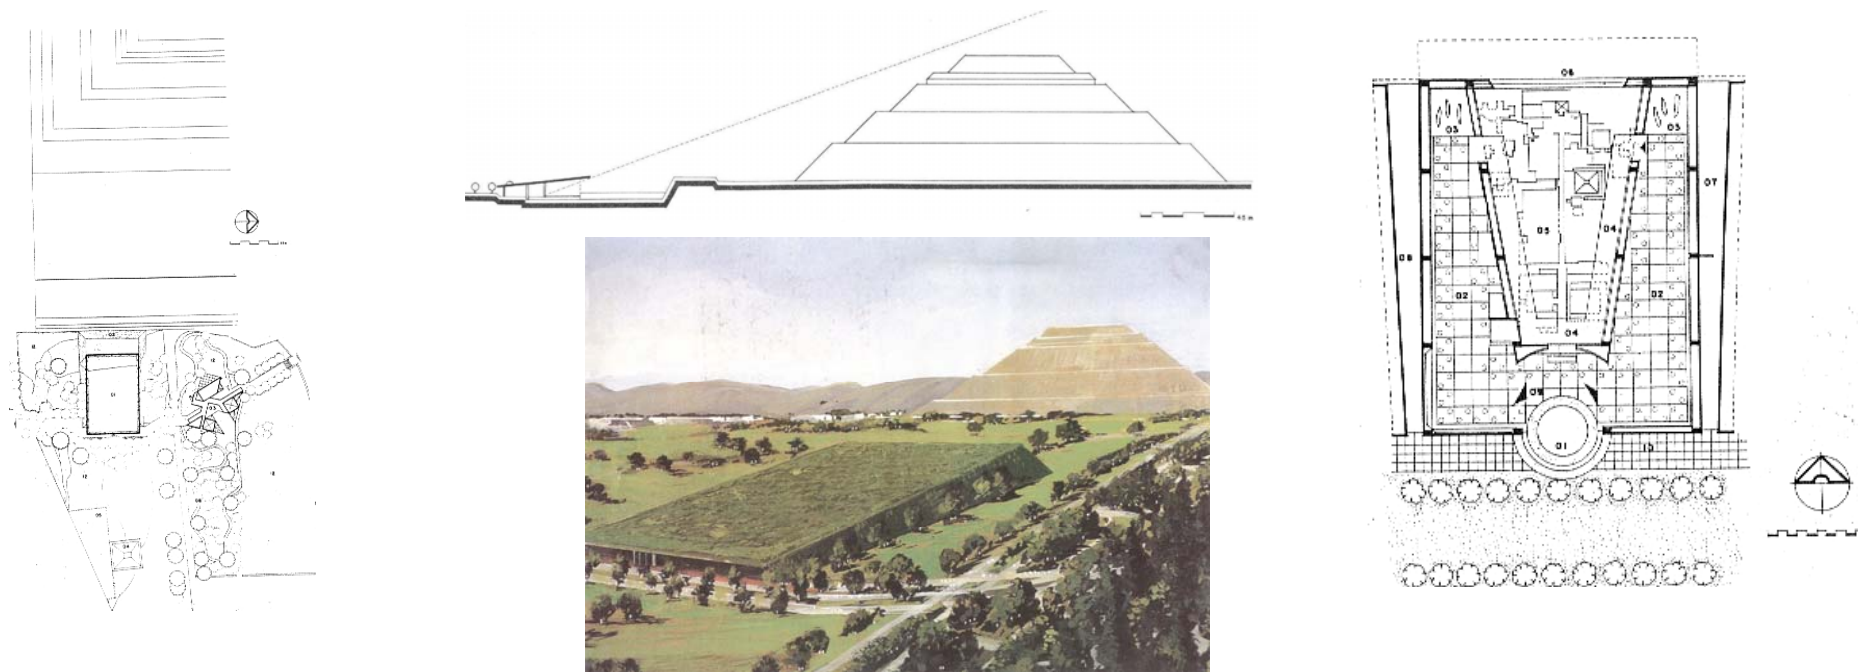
Plantas Arquitectónicas y Corte del Museo de Sitio Teotihuacan diseñado por el Arq. Pedro Ramírez Vázquez.
